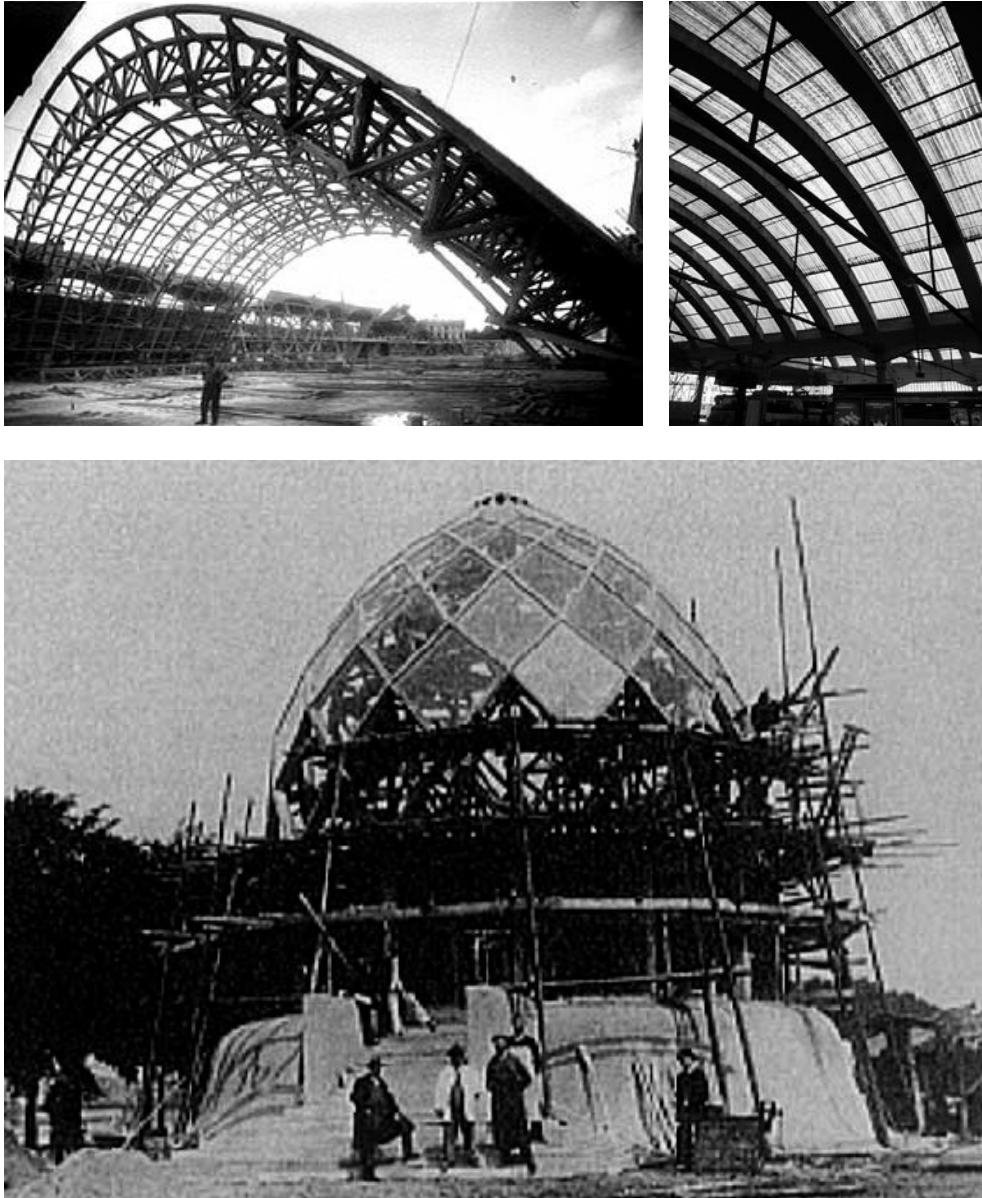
Secuencia de construcción de proyecto de nervaduras estructurales. Airship Hangar (Freissenet, 1921-23), Palacio de Cristal (Taut, 1914).
